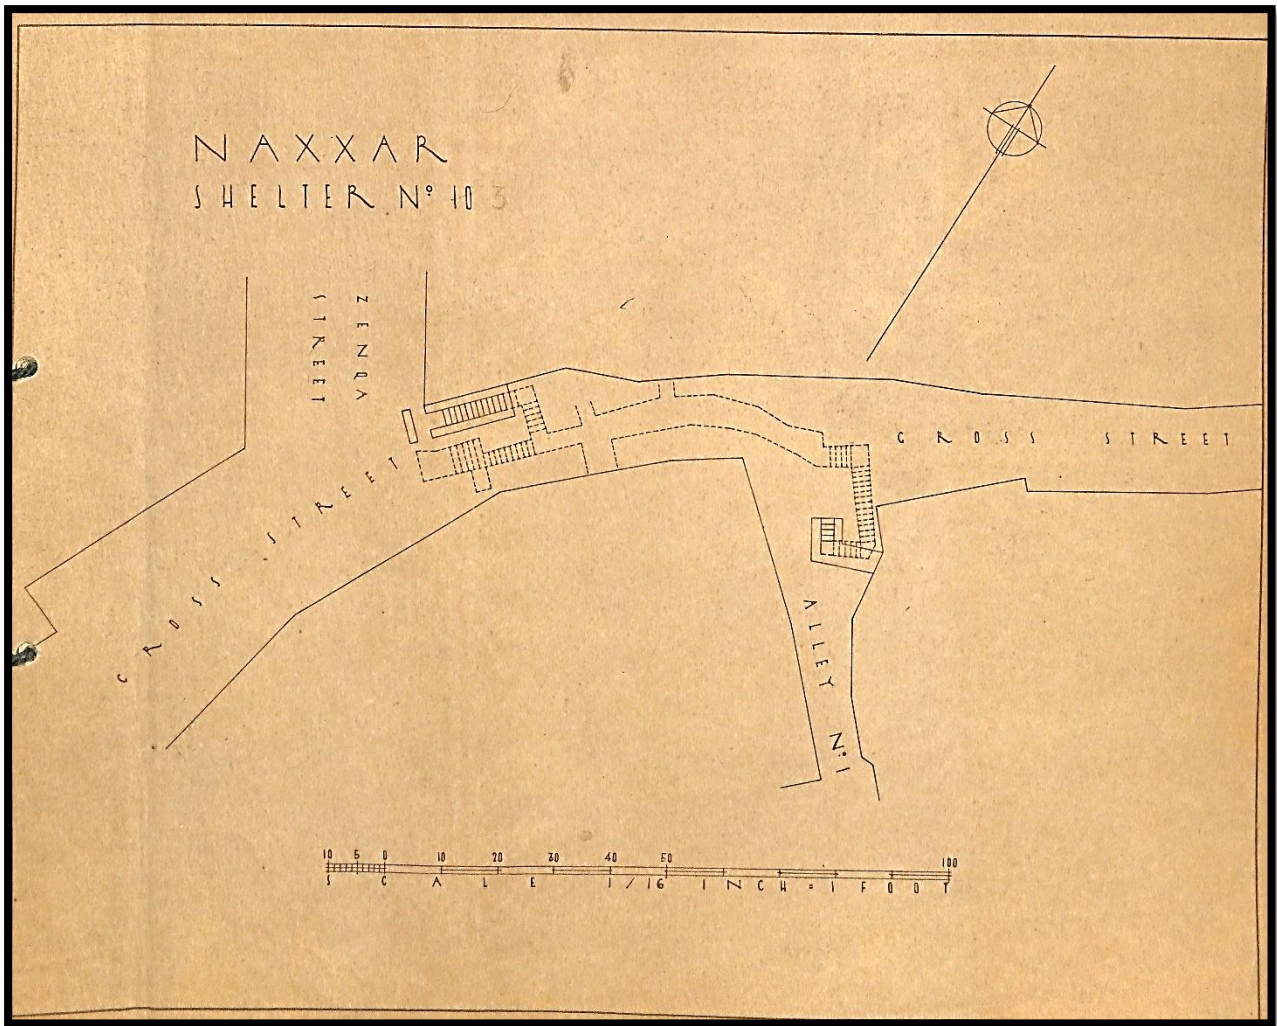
Planta do Abrigo nº10 (3) "Cross Street – Zenqa Street – Alley nº1."
